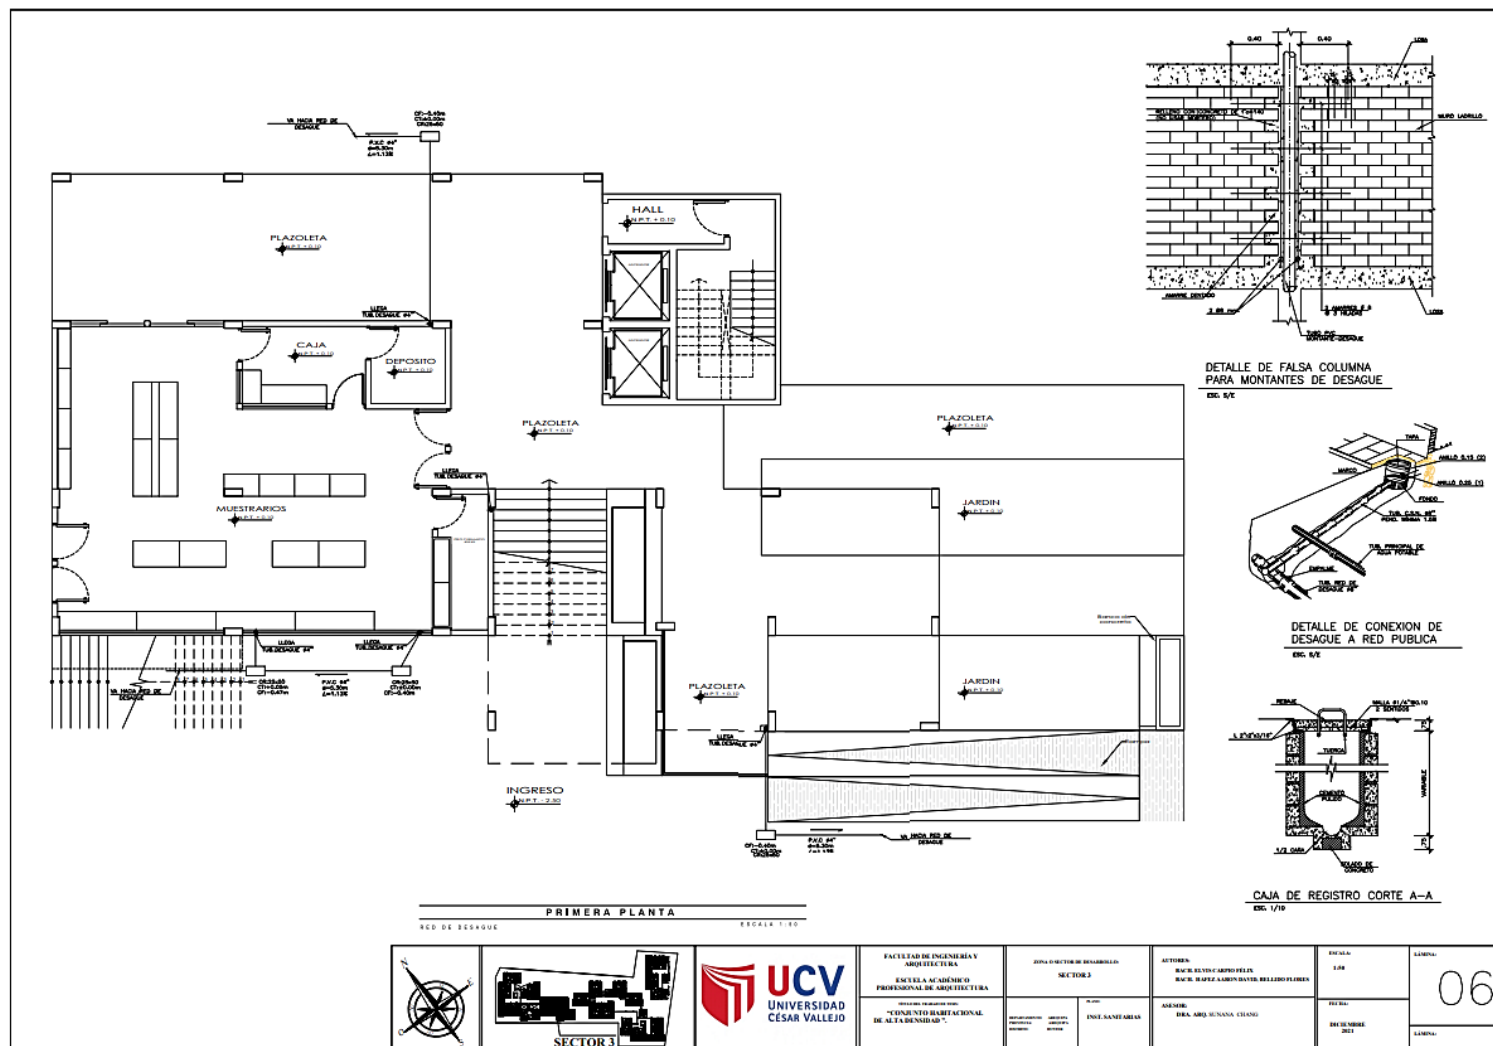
Plano de Distribución de redes de desague y pluvial 1 – Bloque 3 - Primer Nivel
